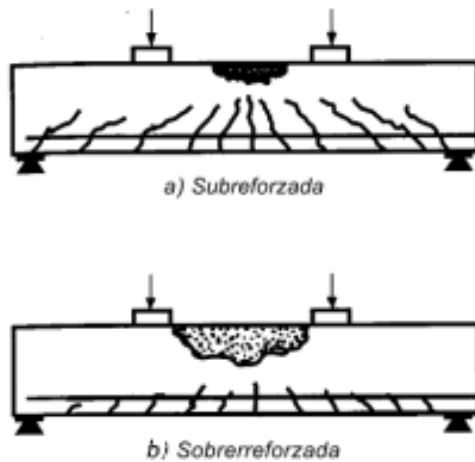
Agrietamiento en la falla de vigas sujetas a flexión
